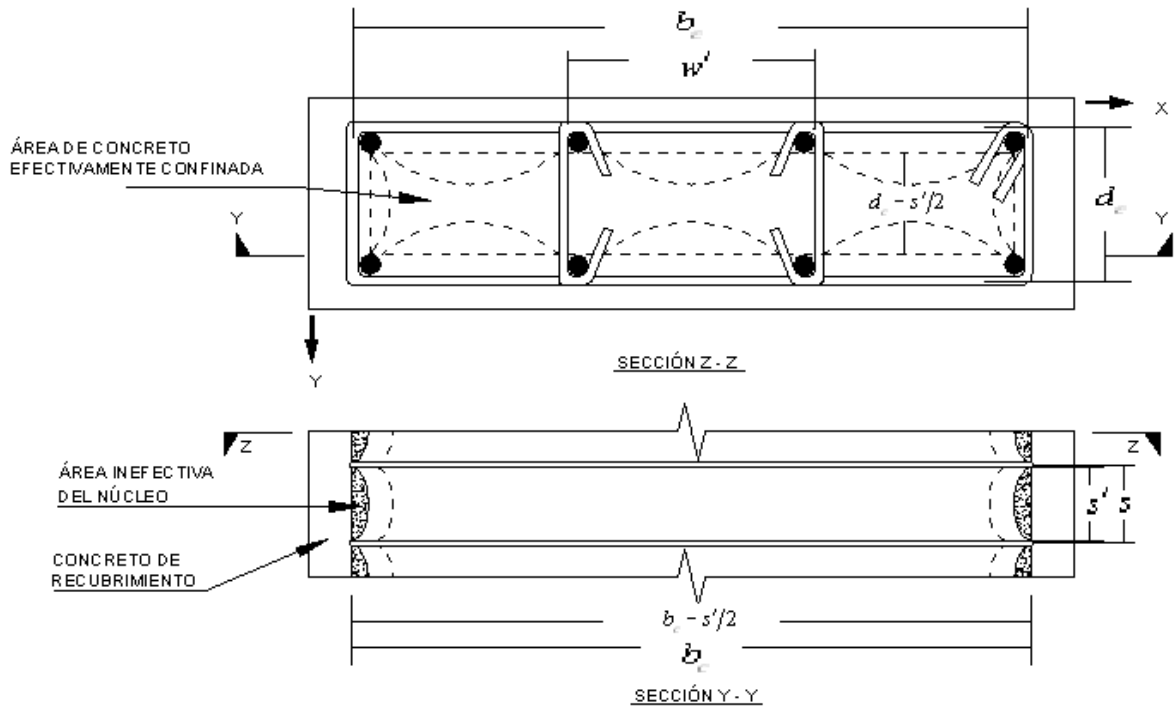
Núcleo efectivo de confinamiento para estribos rectangulares. a) Planta; b) Elevación.
